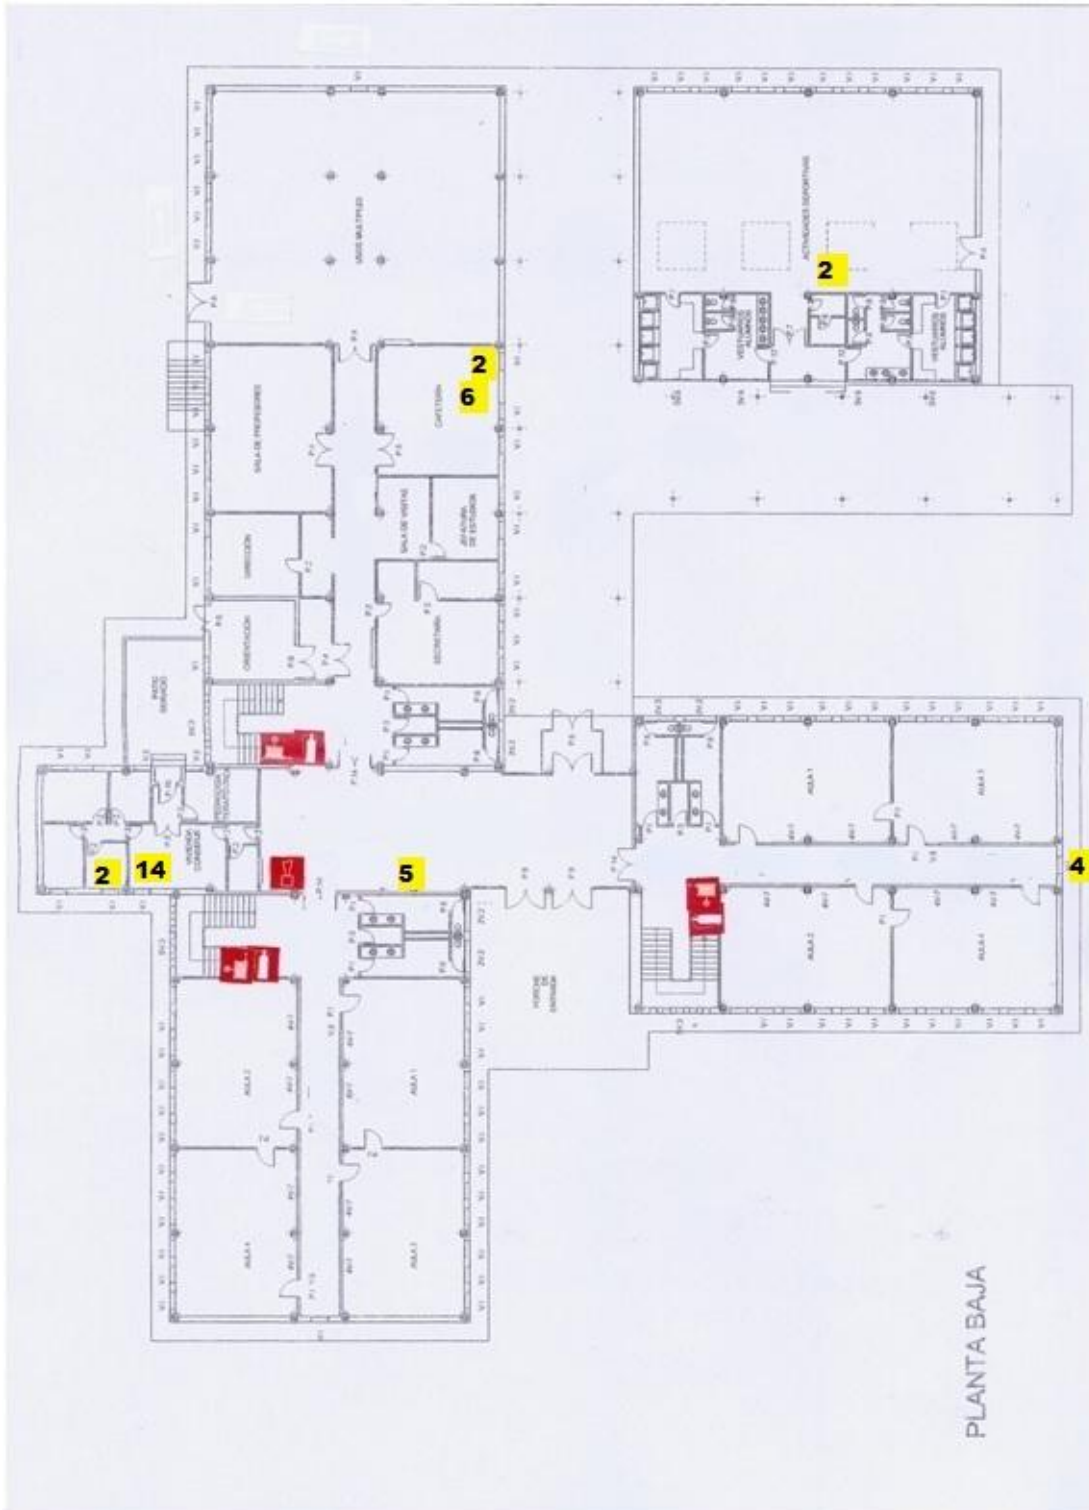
Ubicación elementos e instalaciones de riesgo – Plano planta baja. Fuente: Iván Tejera.
